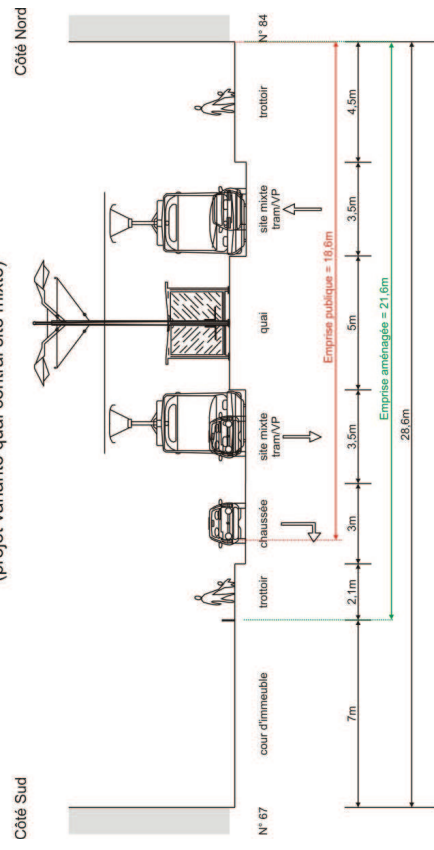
Variante site mixte - coupe 33 (Route des Romains) station "Schnockeloch"
